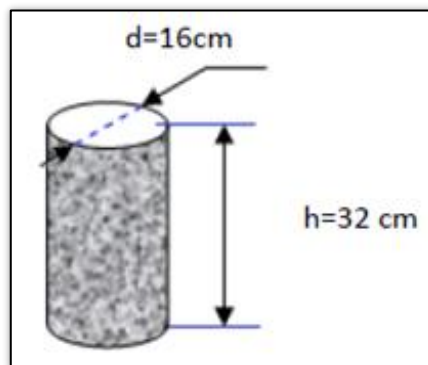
Eprouvette cylindrique (diamètre 16cm, hauteur 32cm)
